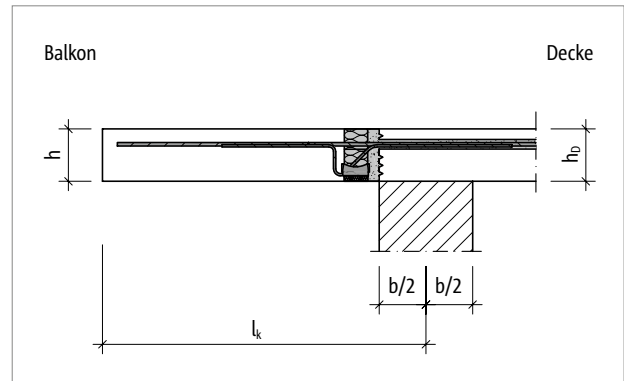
Schöck Isokorb® RT Typ K: Statisches System; direkte Lagerung
